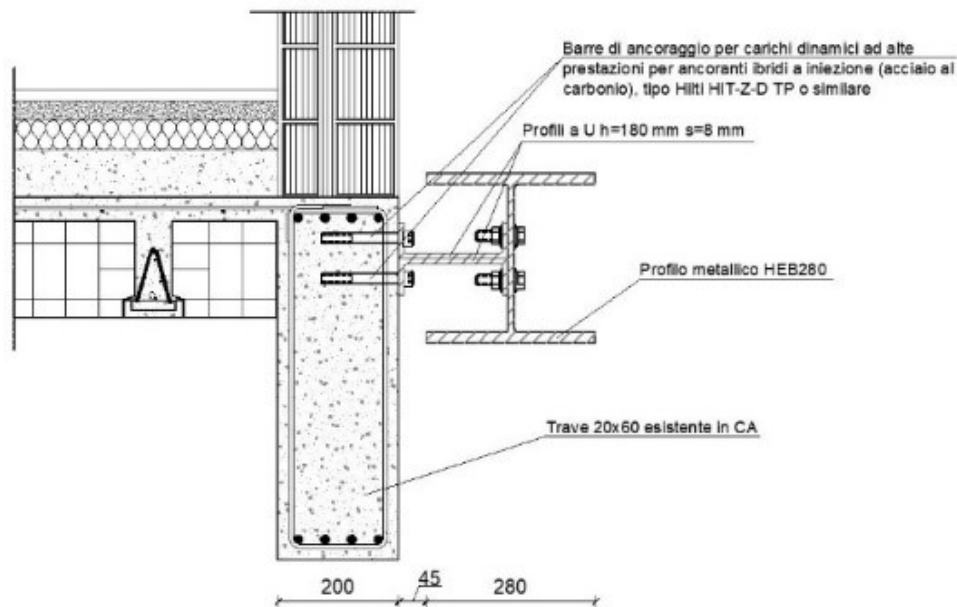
Collegamento dei profili HEB280 alle travi in c.a. sul prospetto ovest (direzione X).
